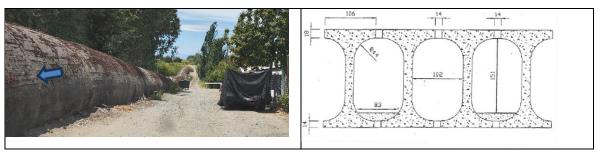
Tubería de hormigón y sección transversal puente sifón
